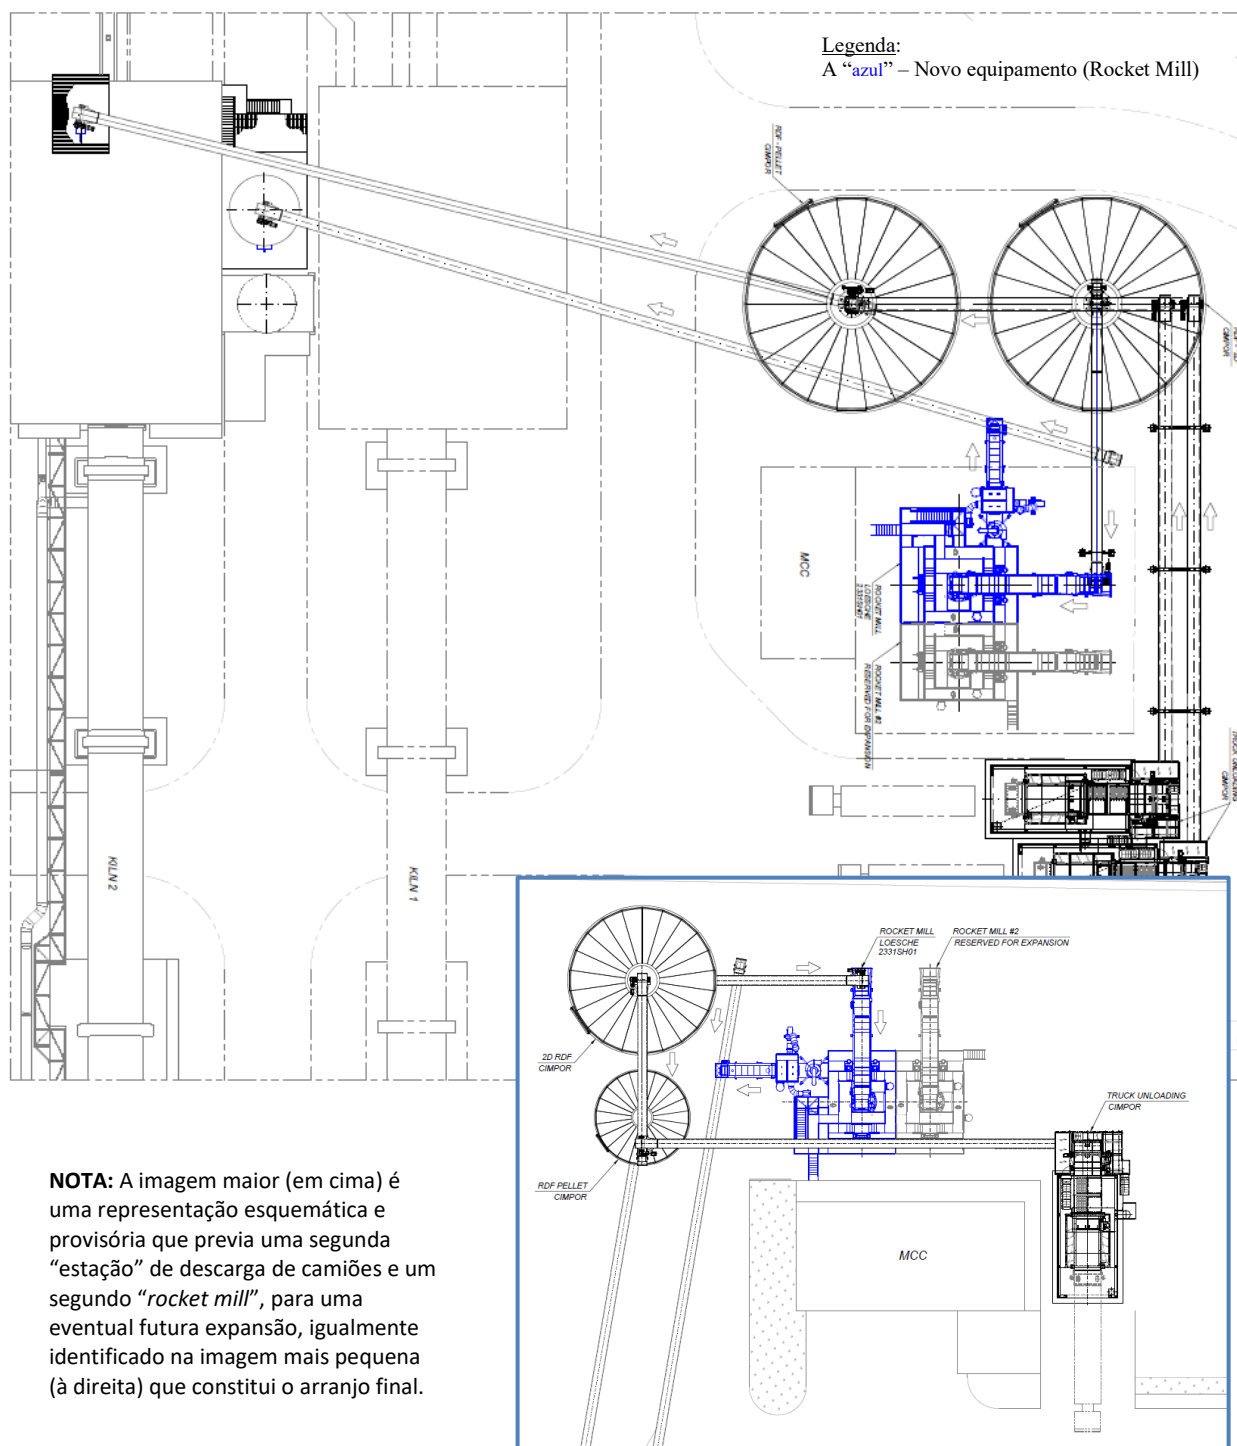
Localização em planta das instalações de CDR para o Forno 2
